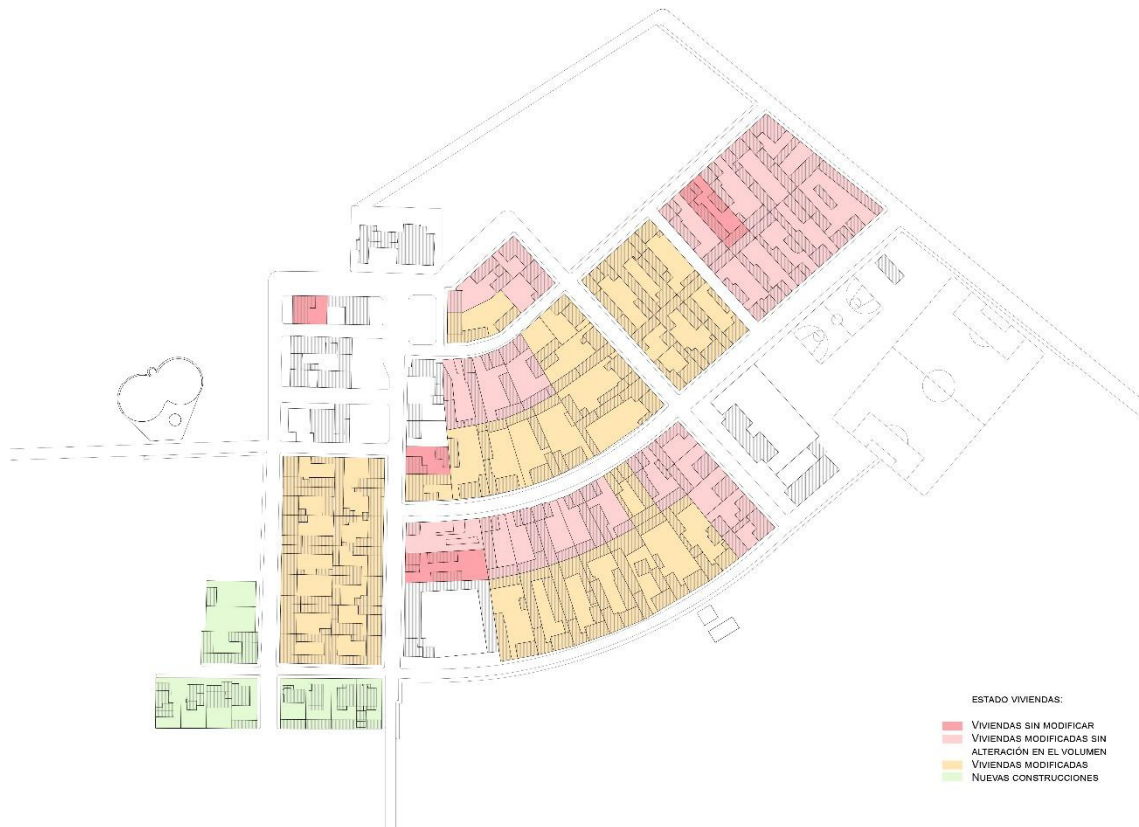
Planta viviendas modificadas hacia el exterior de El Temple. Fuente: Elaboración propia.
